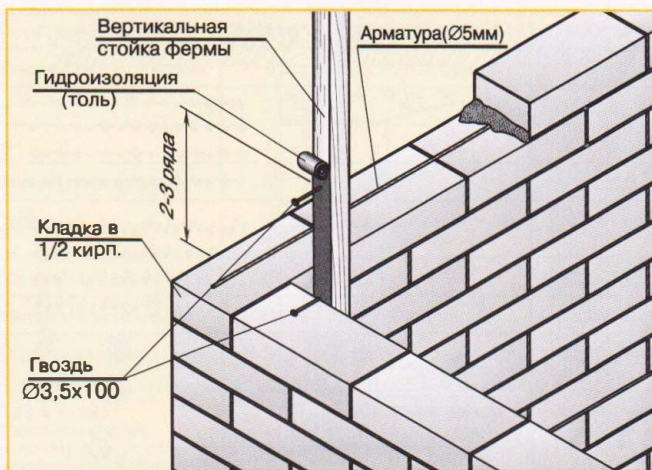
Крепление вертикальных стоек фермы со стенами в процессе кладки.
